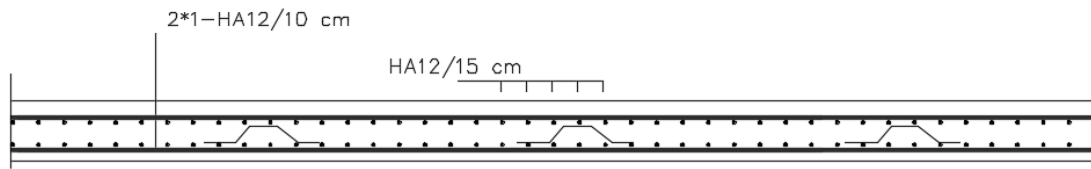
coupe B-B : Ferraillage de la dalle.
